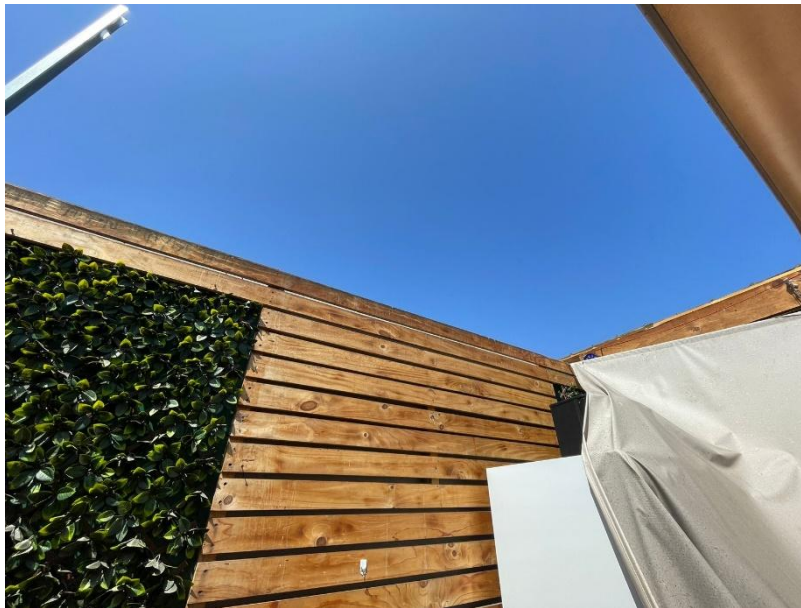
Proceso inicial levantamiento muralla sur 2 piso
